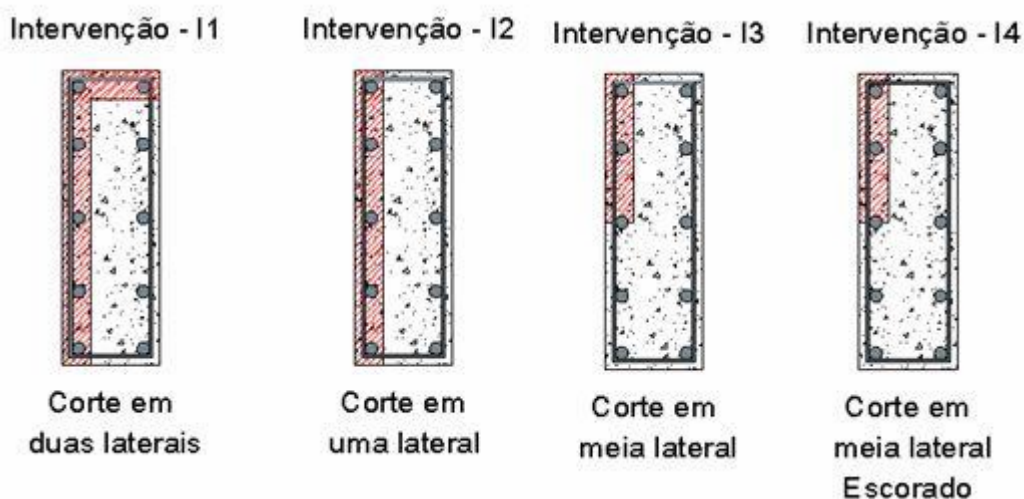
Tipos de intervenções propostas – vista em planta.
